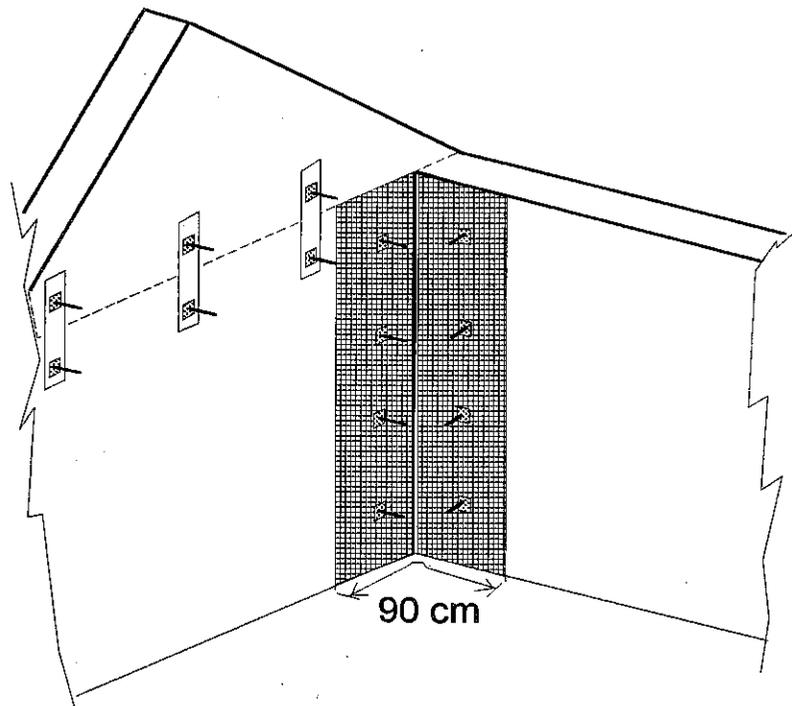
INSTALACION DE LA MALLA VERTICAL CONTINUA (ANCHO 90 cm).
